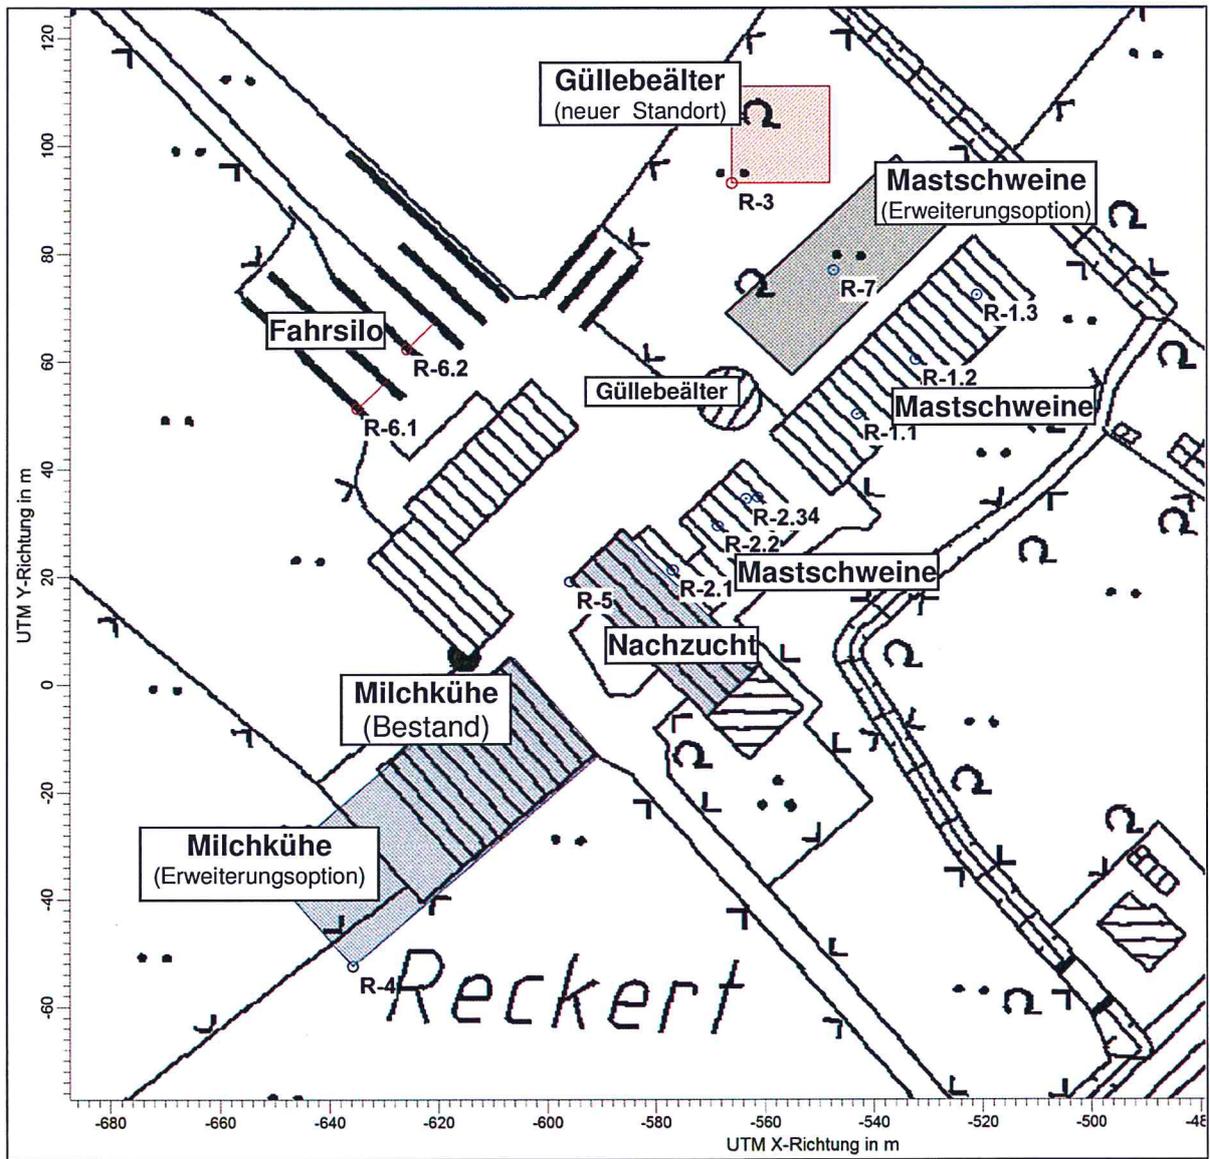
Lageplan Stallanlagen Betrieb Reckert
